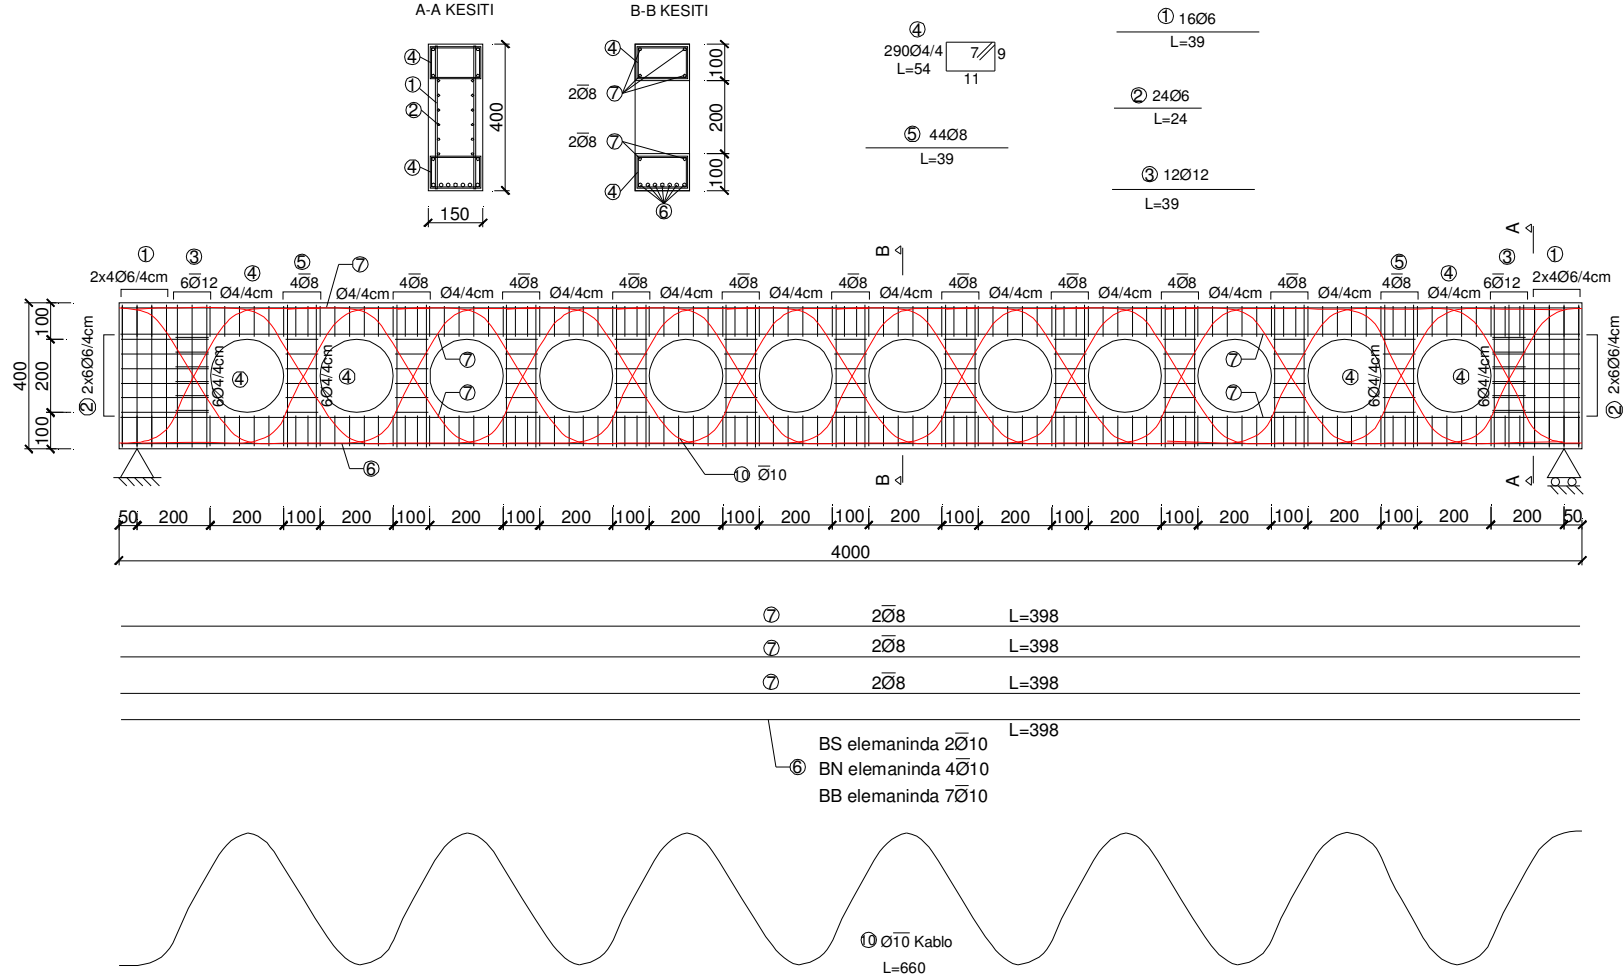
R kodlu kiriş donatı detay çizimi
